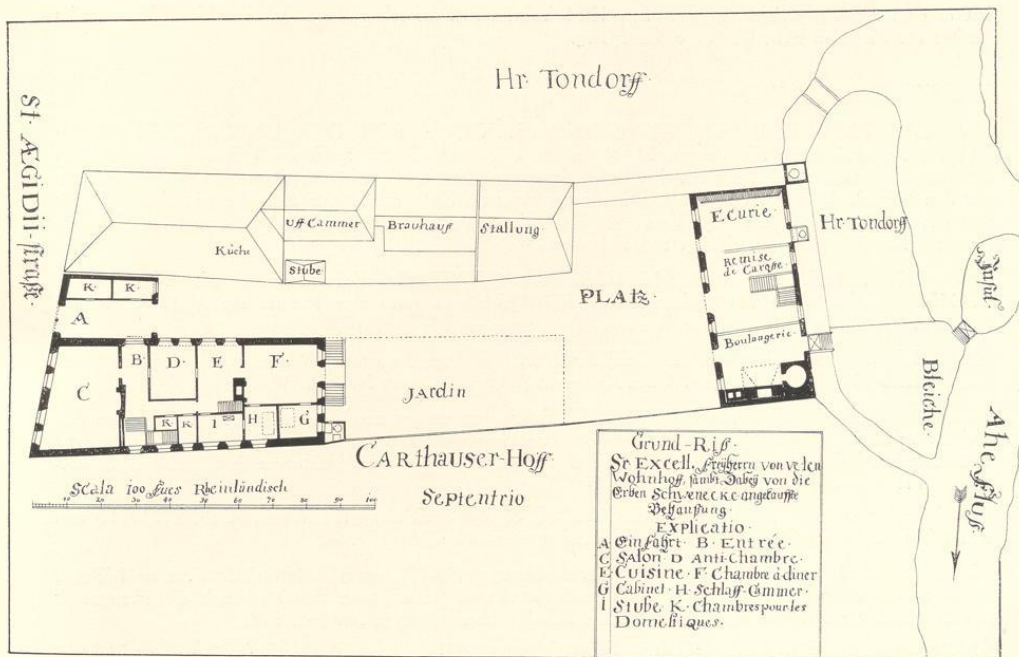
Lageplan der beiden Grundstücke, Norden unten
